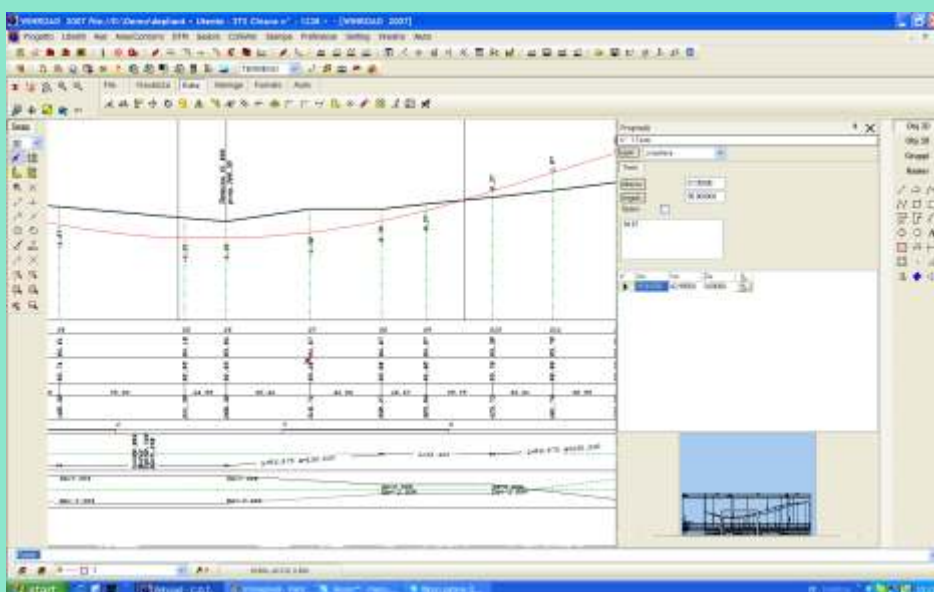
Profilo stradale completo di andamento planimetrico, cigli e quote
